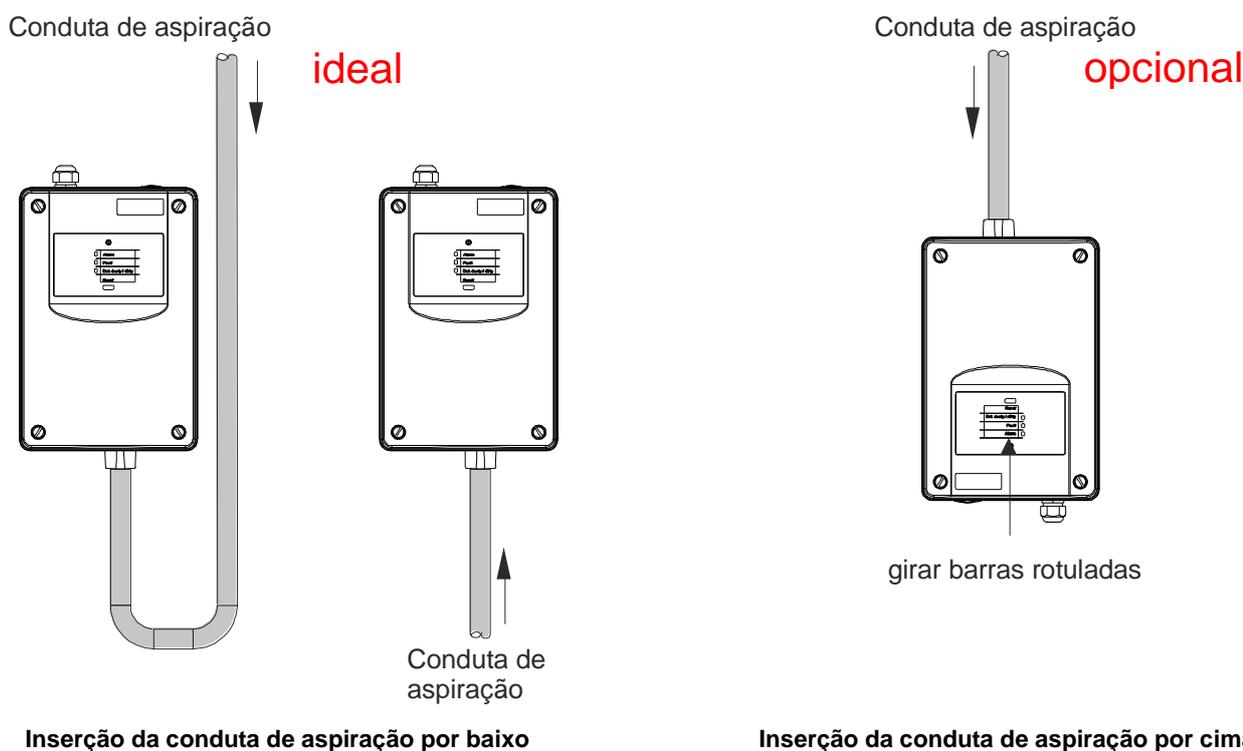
Posição de montagem e inserção dos tubos na caixa para detetor
